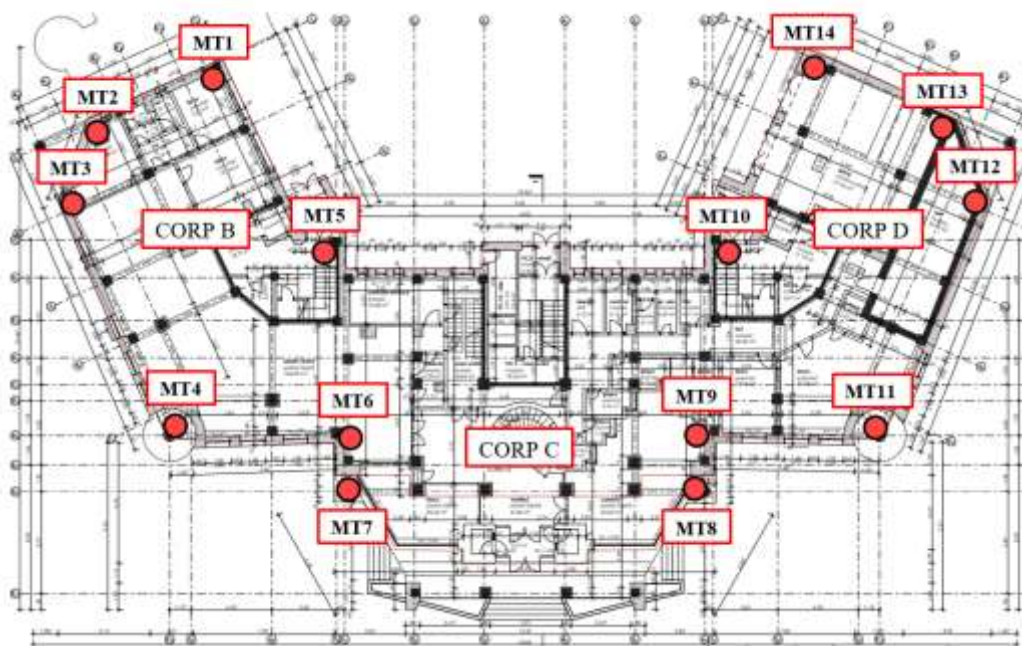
Plan amplasare mărci de tasare pentru construcția existentă – plan parter
